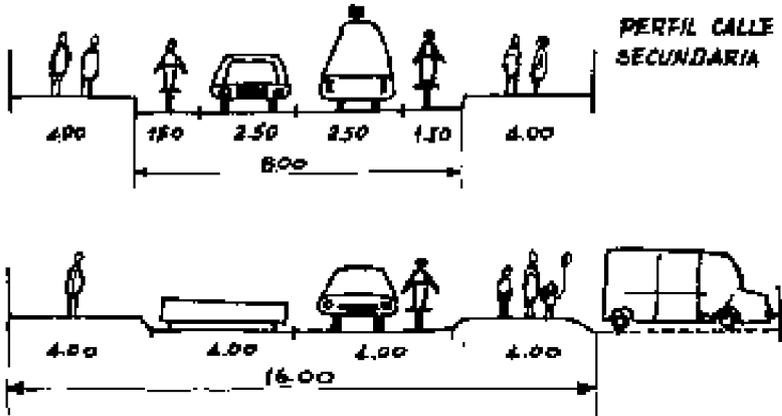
Perfil calle secundaria. Fuente: INEN GP 029
